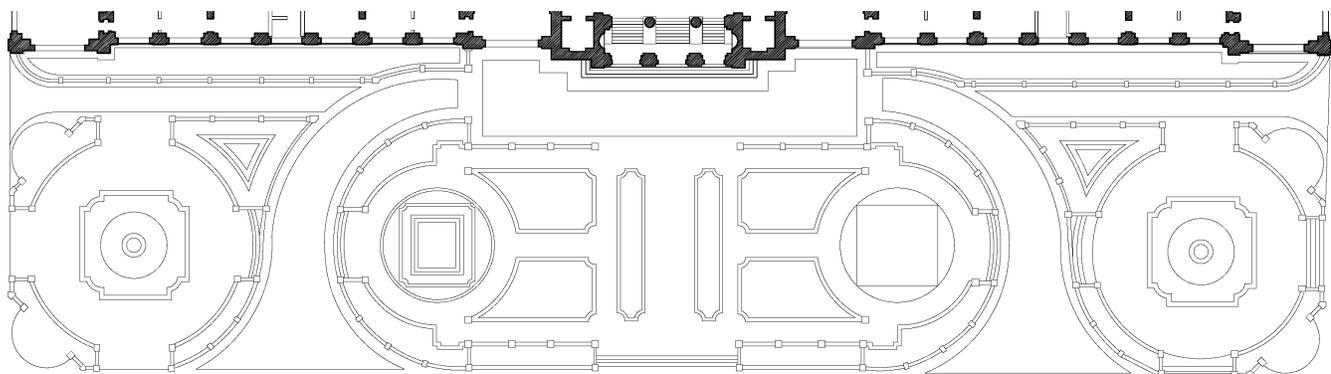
Planimetría Plaza Montt Varas. Elaboración propia
